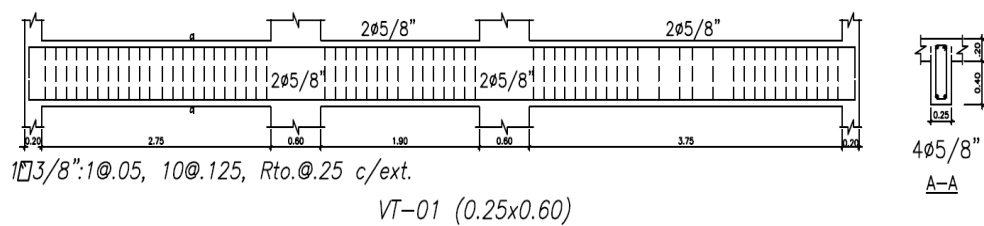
13 Vista en Elevación de la distribución del acero en la viga VT-01
